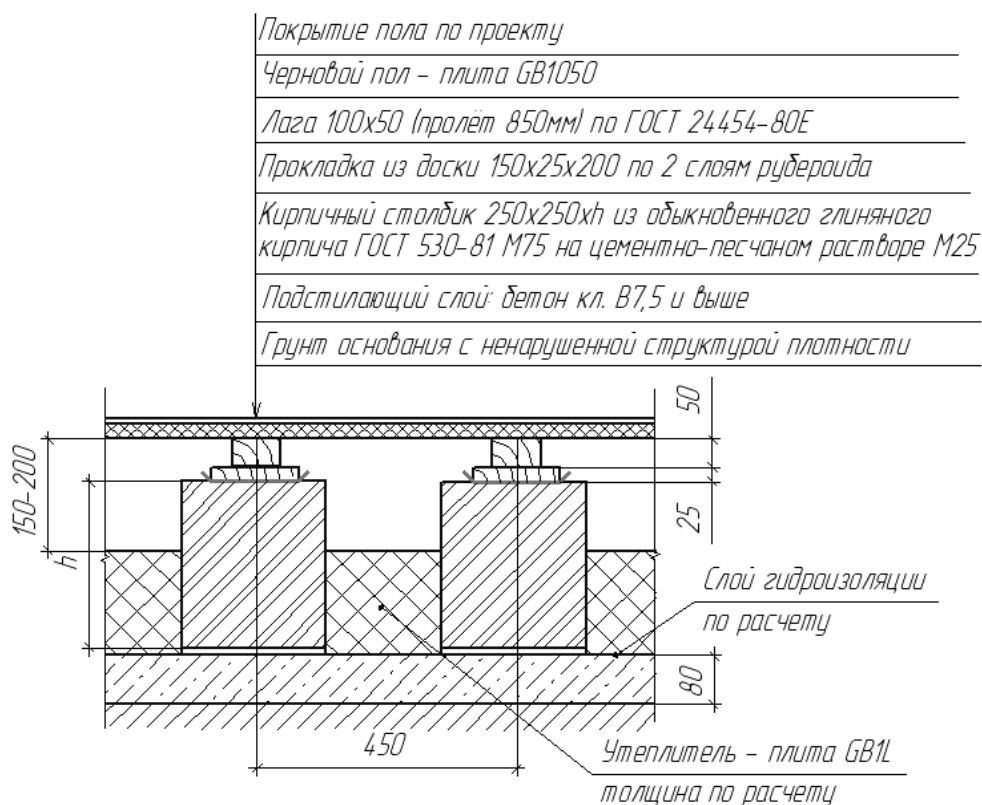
Конструкция пола по грунту с утеплением с покрытием на кирпичных столбиках с применением системы плит GREEN BOARD®
